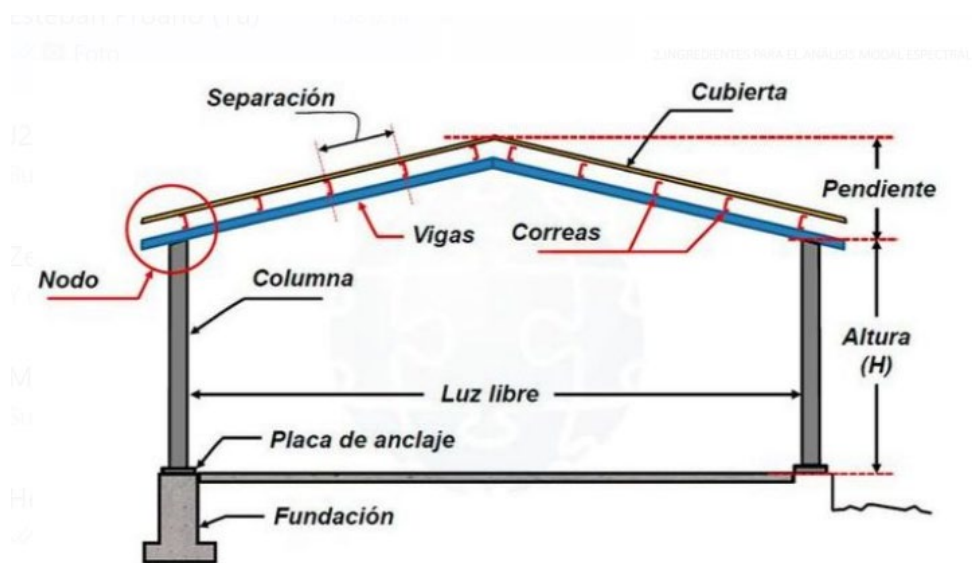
Sección transversal que muestra un pórtico y sus restricciones
